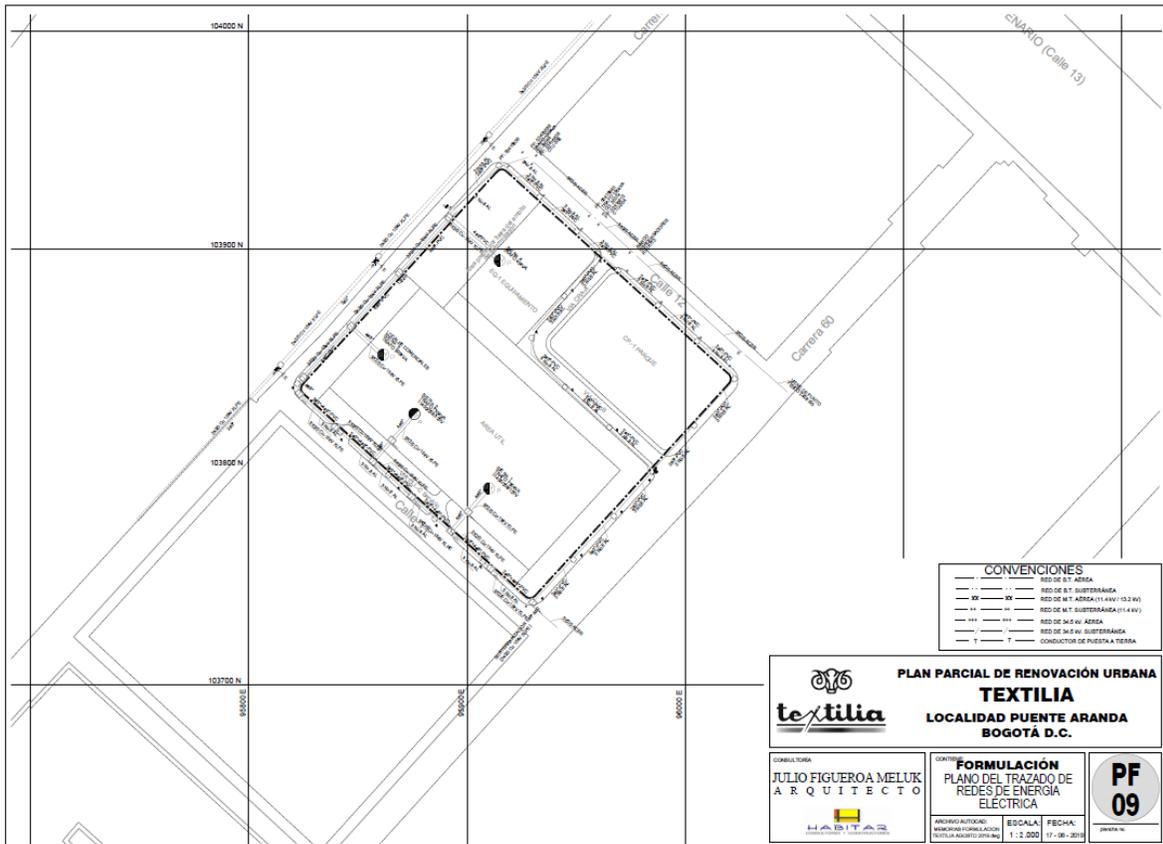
Plano PF-09 Trazado de Redes de Energía Eléctrica
